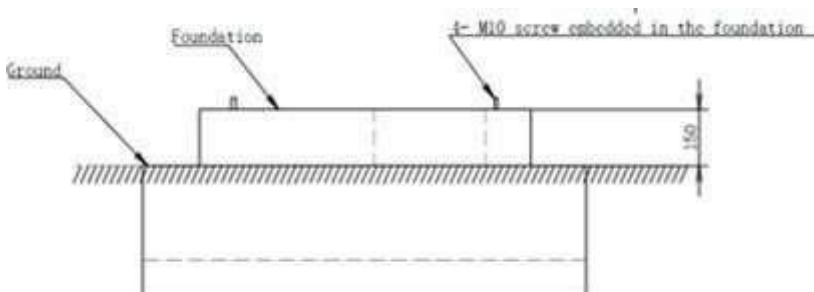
Directrices para la construcción de la base de mampostería para la fijación del cargador Nansen DC
